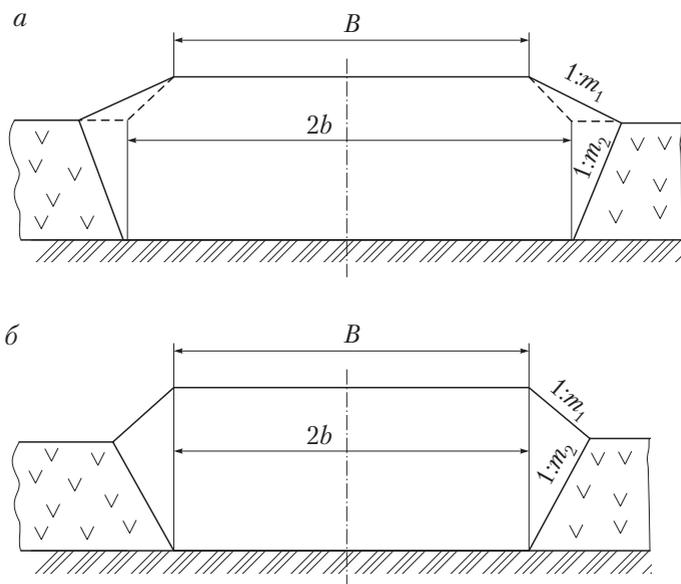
Схемы земляного полотна с удалением слабых грунтов в основании:
